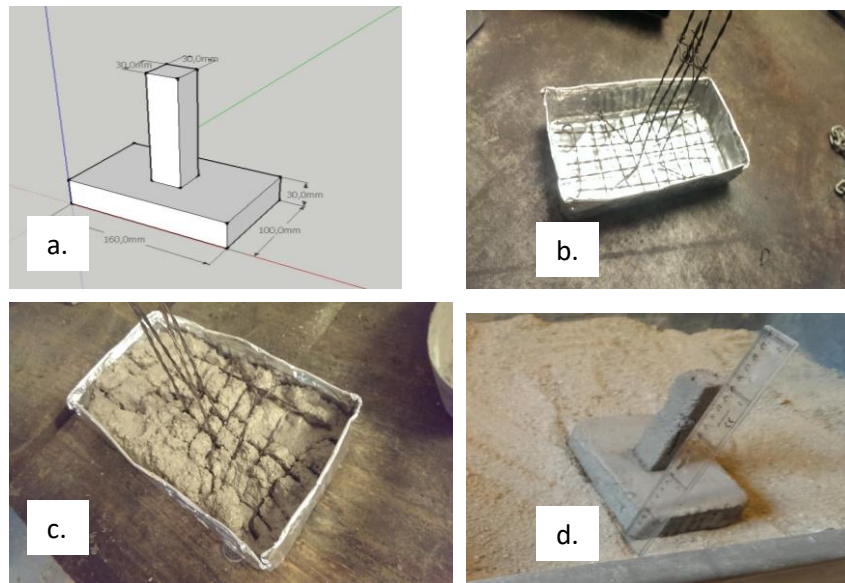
11: Construcción de la zapata a escala de hormigón armado: a) Medidas de la zapata a escala, b) Encofrado y armado de la zapata, c) Hormigonado de la zapata, c) y d) Modelo a escala terminado.
